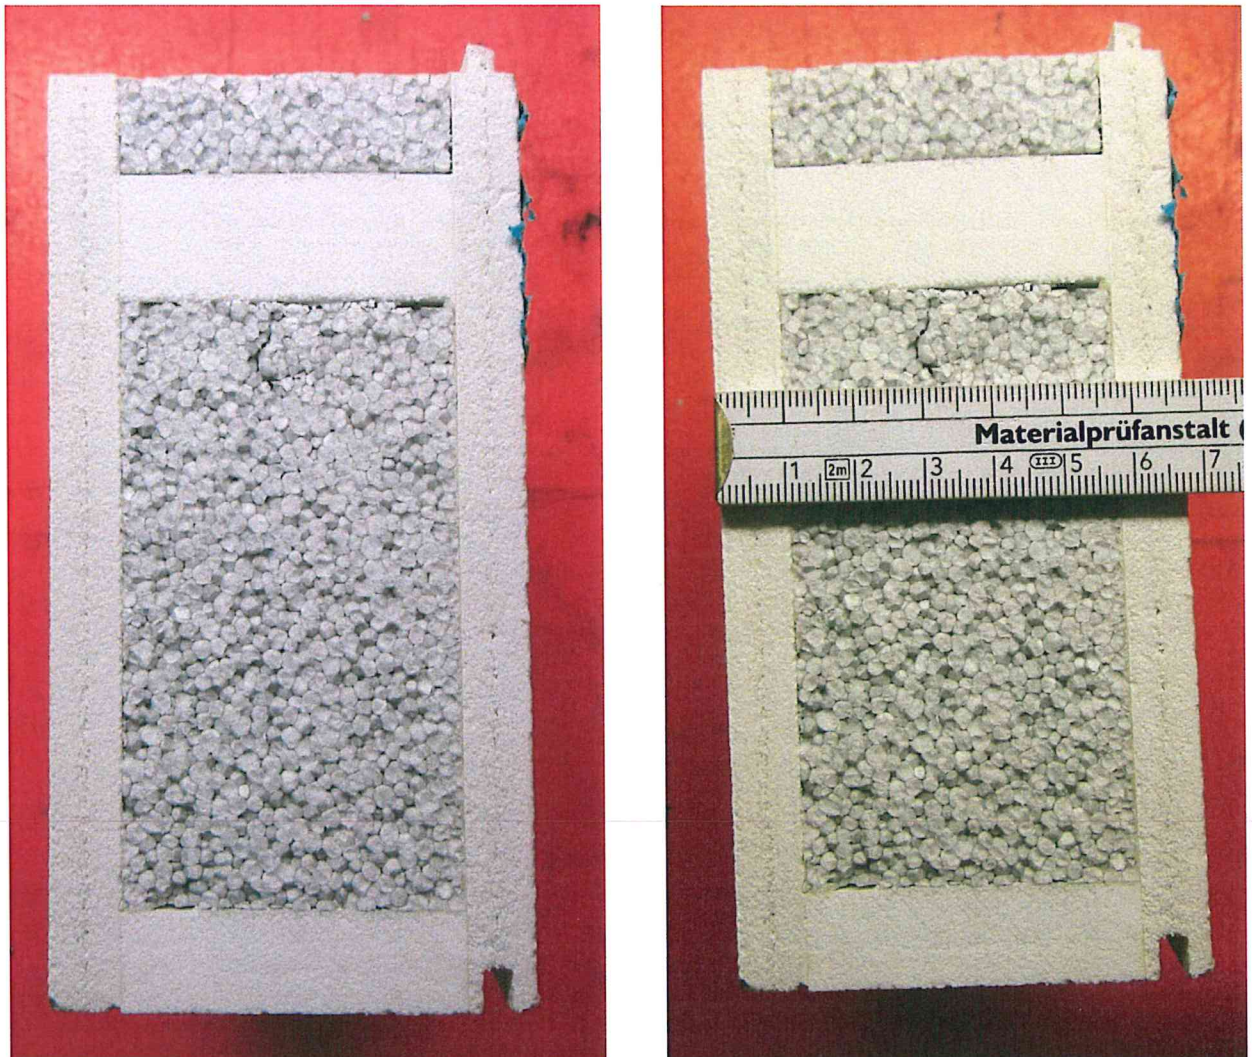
Ansicht und Detail vom blaugelb Sockeldämmprofil (IHP/EPS), $d_{\text{Profil}} = 69 \text{ mm}$
